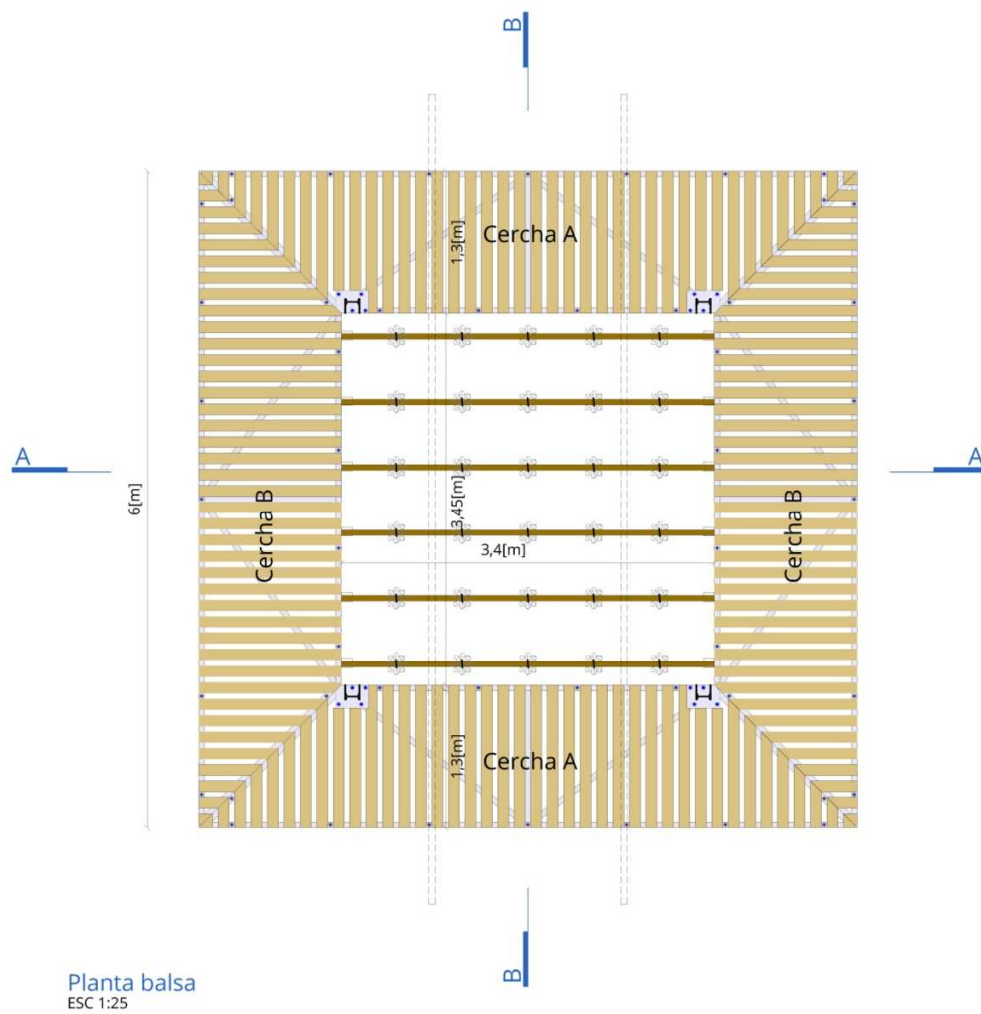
Planta de la balsa. FUENTE: Elaboración propia.
